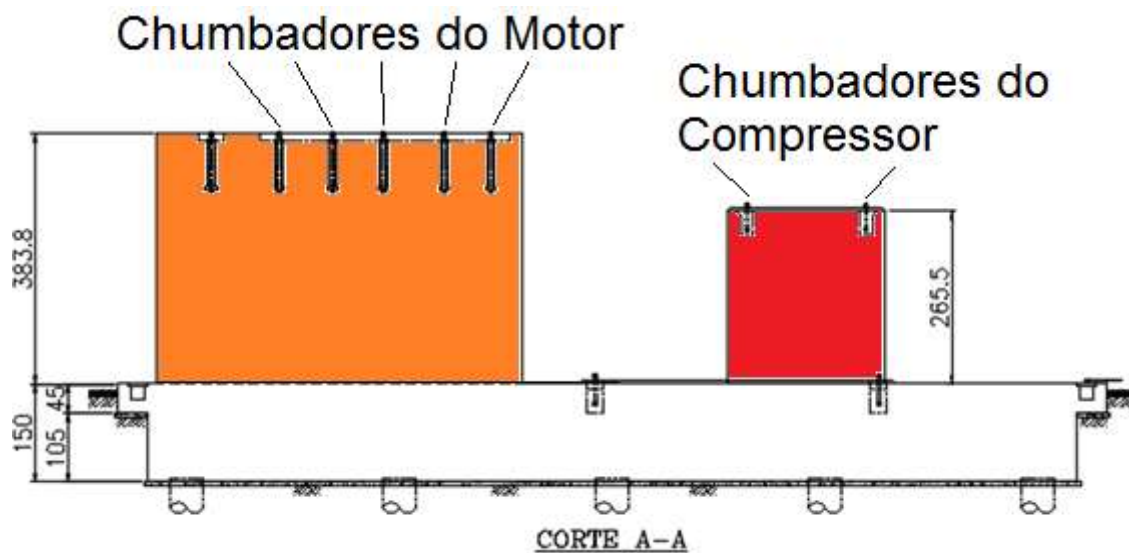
Modelo estrutural: elevação da fundação (Corte A-A) [3].
